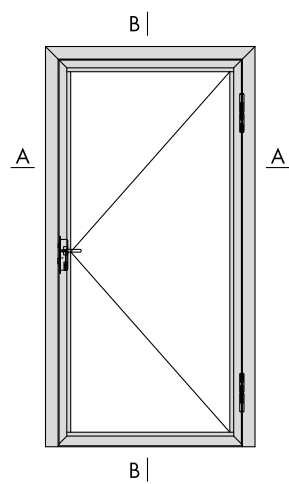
Porte profilée coupe-feu en acier, système Jansen.
